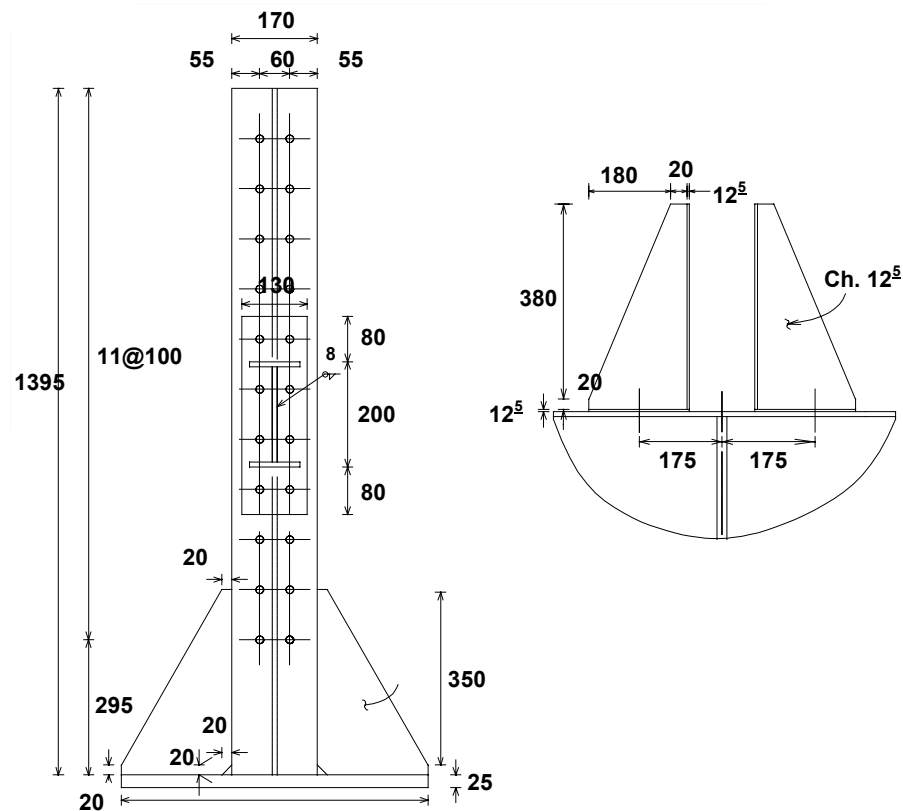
Detalhamento dos pilares e dos consolos dos pórticos de apoio dos protótipos
